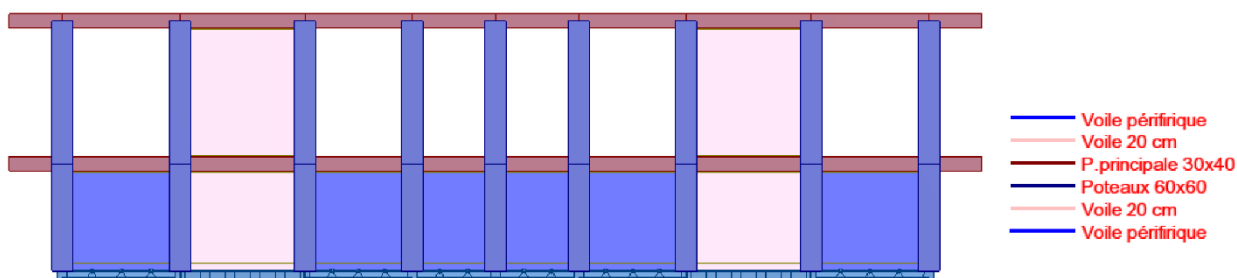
Schéma des voiles périphériques longitudinaux avec les poteaux et les poutres.
